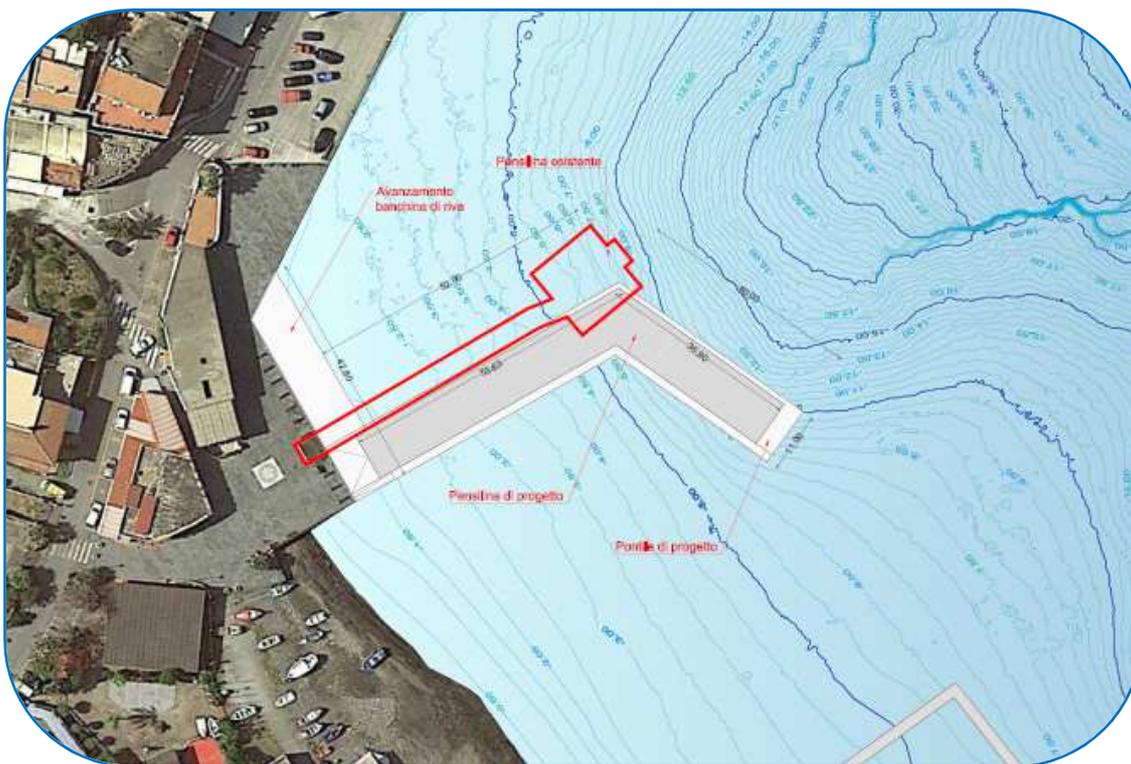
Planimetria esemplificativa dei lavori in progetto rispetto al pontile esistente.
